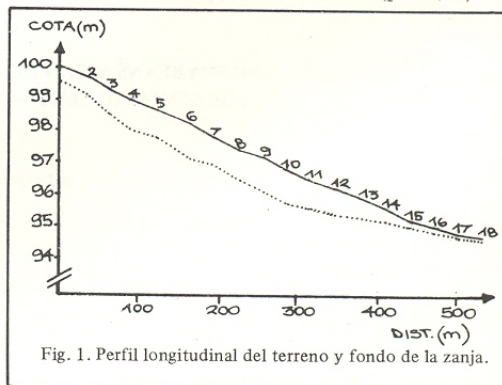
Perfil longitudinal del terreno y fondo de la zanja.
